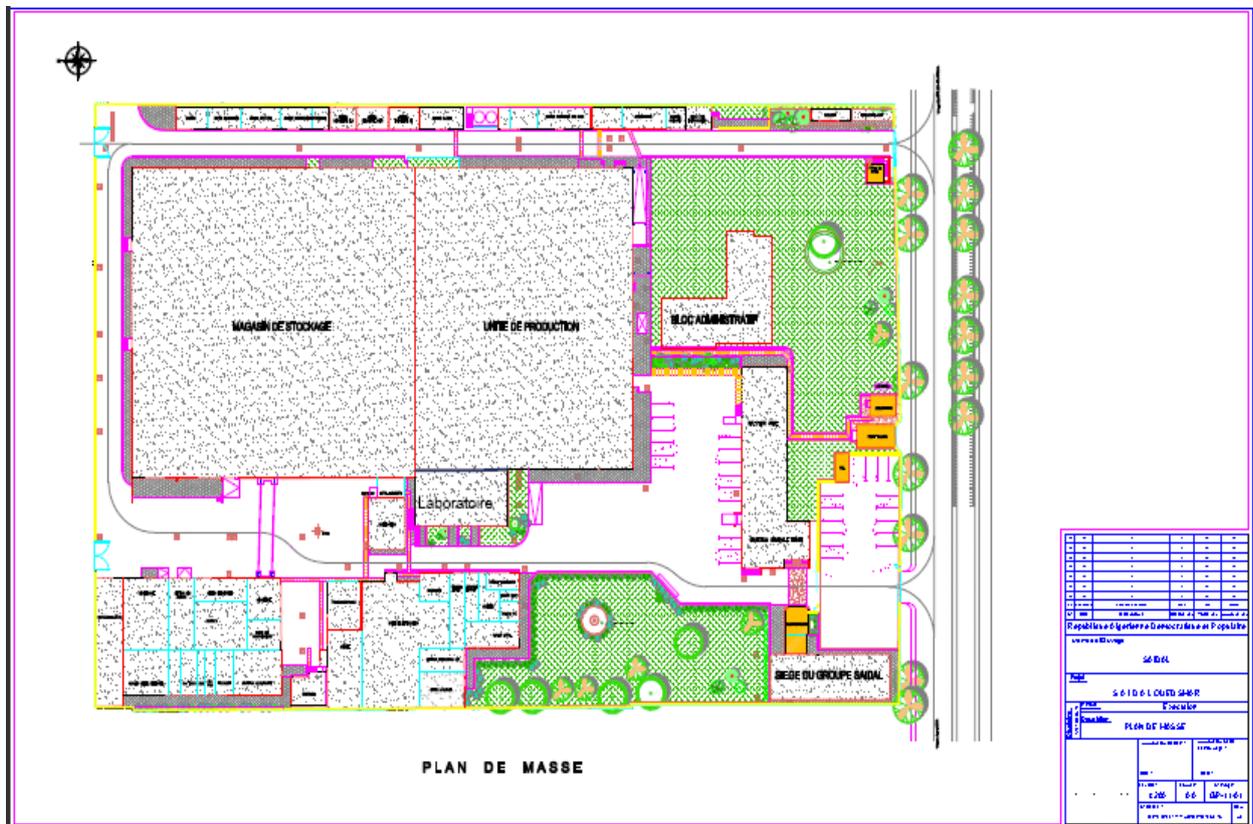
Plan de masse d'usine SAIDAL Dar El Beida.
